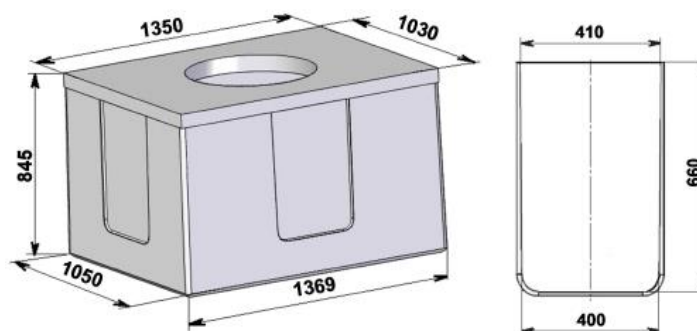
Габаритные размеры и размеры ниш «ККСр-1-10(80)».
